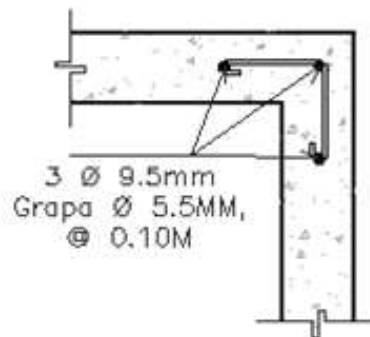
j Detalle típico de refuerzo en extremo de pared
